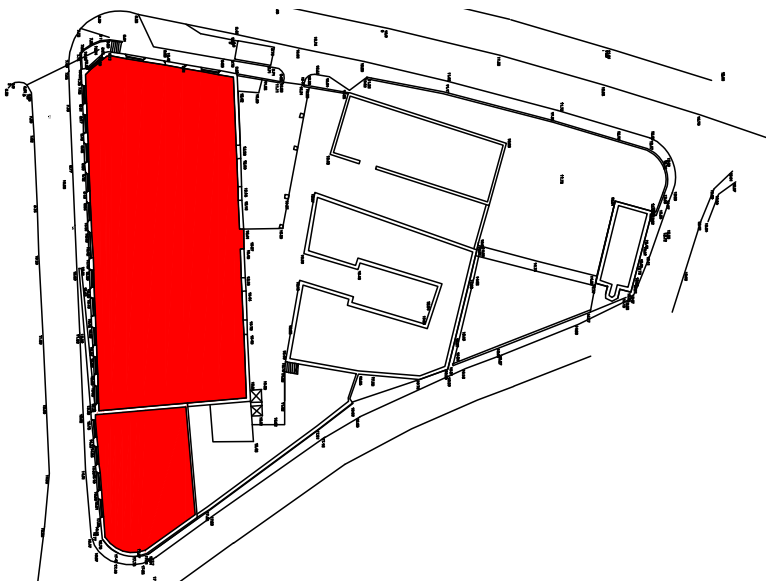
Planta do existente. A vermelho o edifício principal da fábrica. Fonte: Autor
